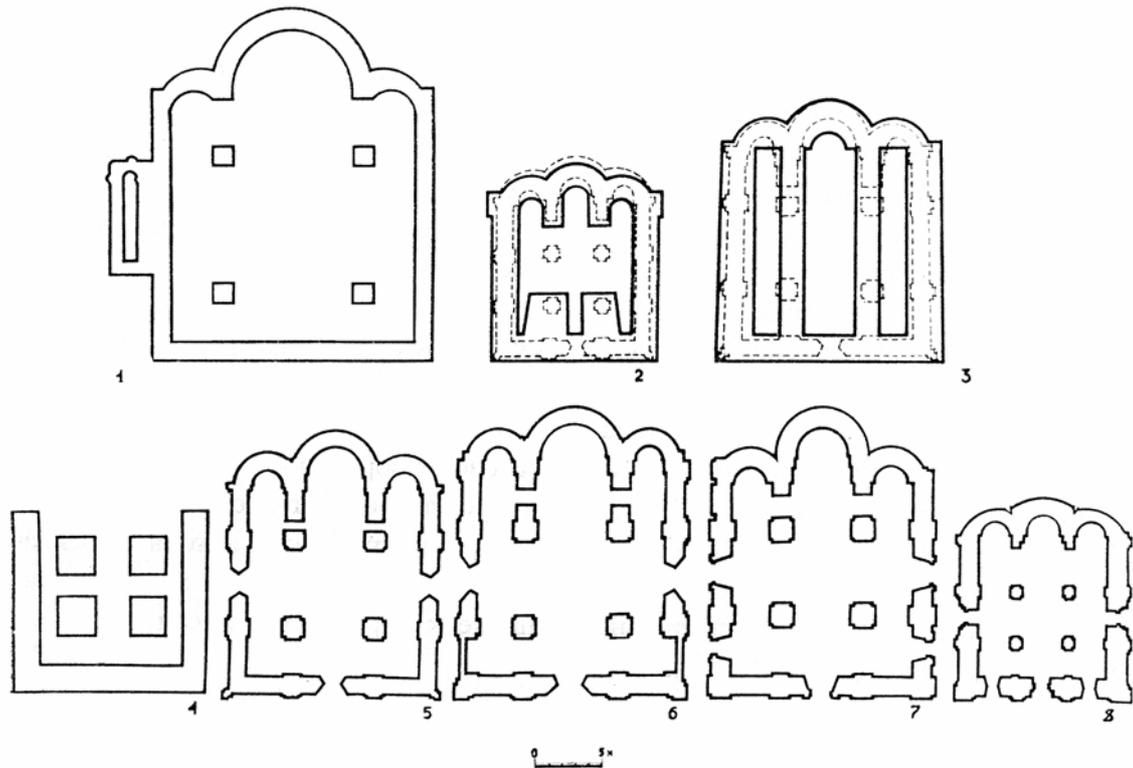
Grundrisse der Kirchen des 12. Jh. aus Galitsch und Wladimir-Suzdal:
